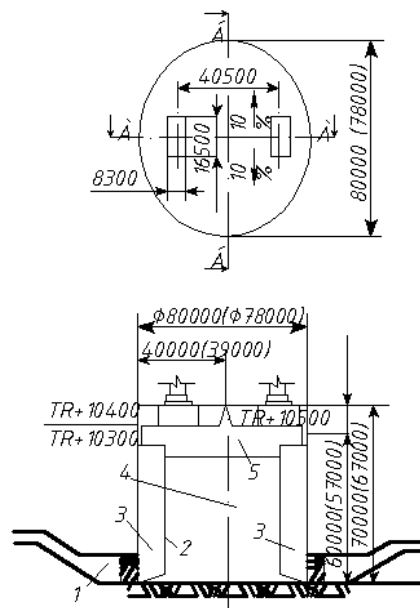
Фундамент пілона в плані й у вертикальному розрізі (розміри вказані для більшого фундаменту, в дужках — для меншого): 1 — протиерозійний шар; 2 — металева оболонка; 3 — порожнисті стінки; 4 — ділянка підводного бетонування; 5 — ділянка звичайного бетонування.
